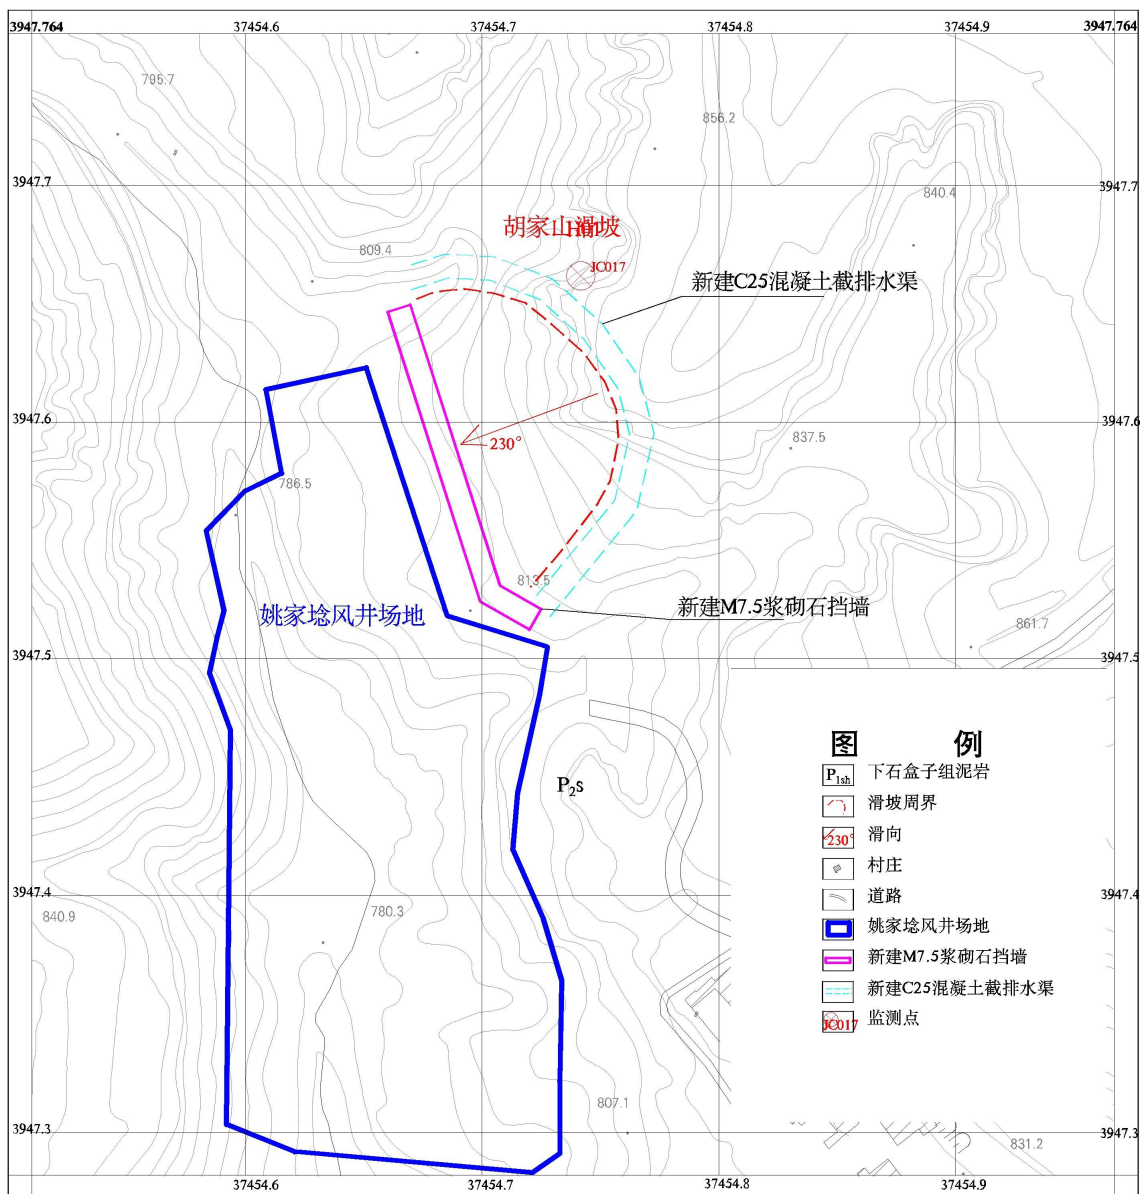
胡家山滑坡隐患（H01）治理工程部署平面图
